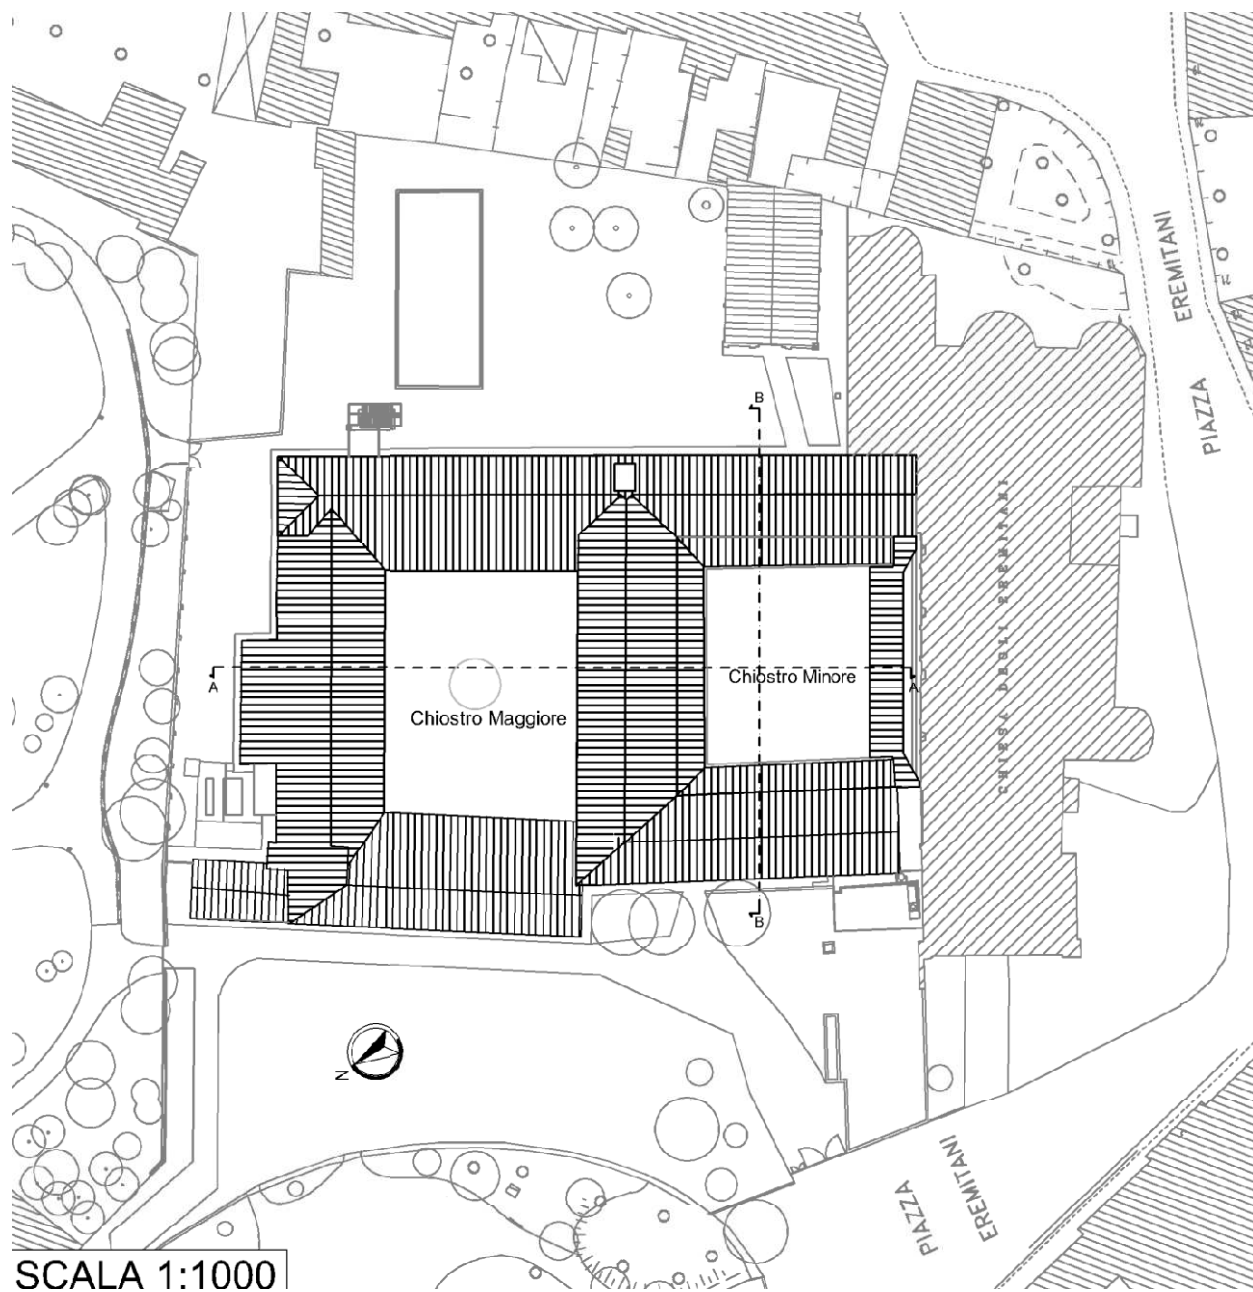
Planimetria generale del Complesso degli Eremitani.
